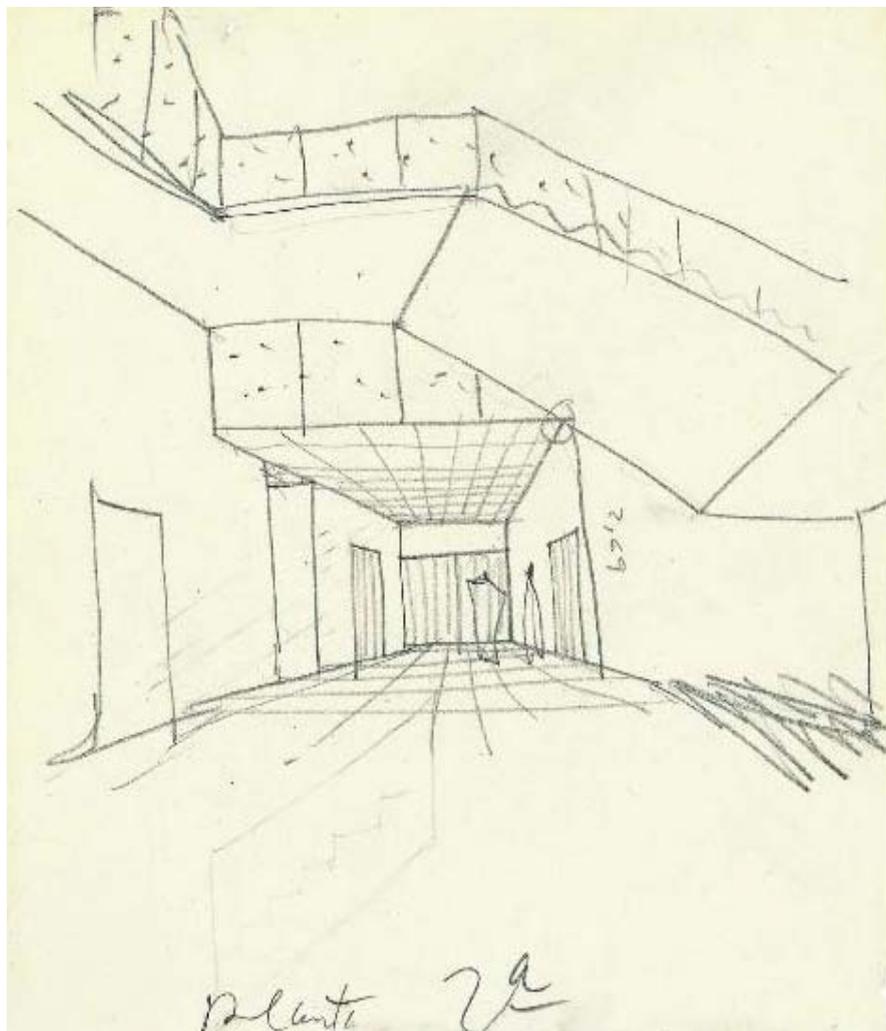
Croquis de Sota de llegada de la escalera principal a la planta segunda. Fundación Alejandro de la Sota.
